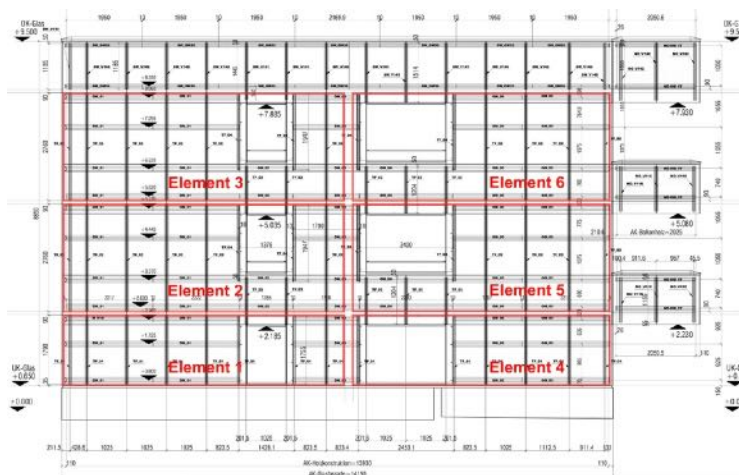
Südwestfassaden mit den eingezeichneten Holzbauelementen Prototyp Vorfabrikation Unterkonstruktion
